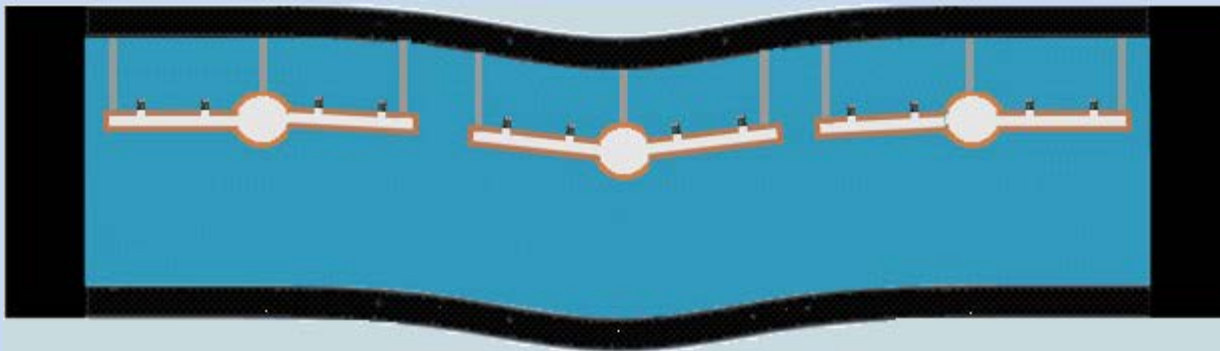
Начальный период резонансных колебаний. Положение жёстко подвешенных распределительных  и питающих  трубопроводов при отклонении упругой конструкции из плит подвала вниз от положения устойчивого равновесия. -спринклер. -подвеска.
